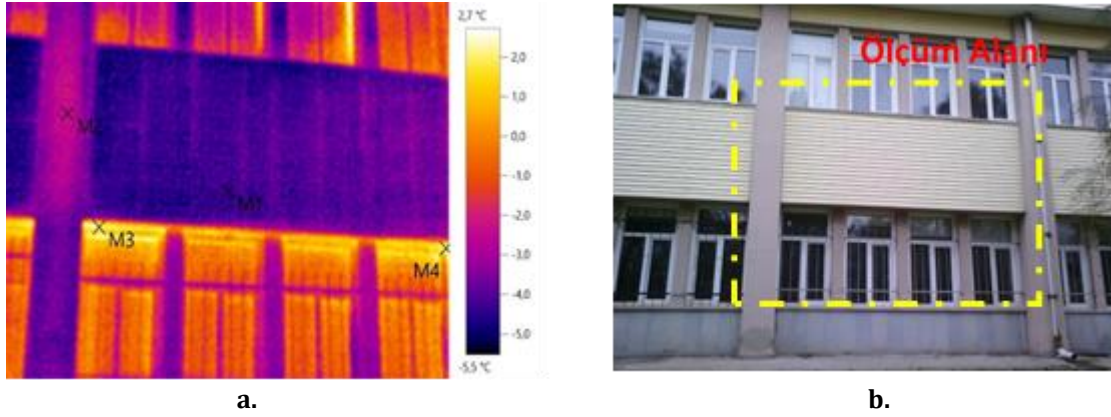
E 4 Binası Güney Cephesi Dekanlık Girişi, A. Termal Kamera Görüntüsü, B. Gerçek Görüntü (E 4 Building South Facade Dean Building Entrance, A. Thermal Camera Image, B. Real Image)
